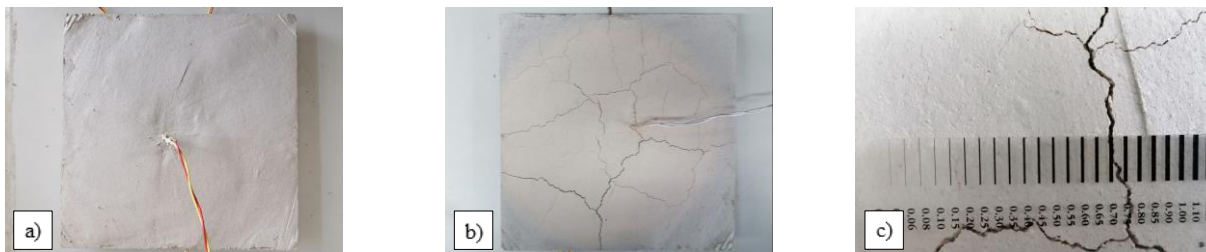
Provete P_A5_1_LA: a) Provete antes do ensaio; b) Provete após o ensaio; c) Fissuração do provete após o ensaio.
